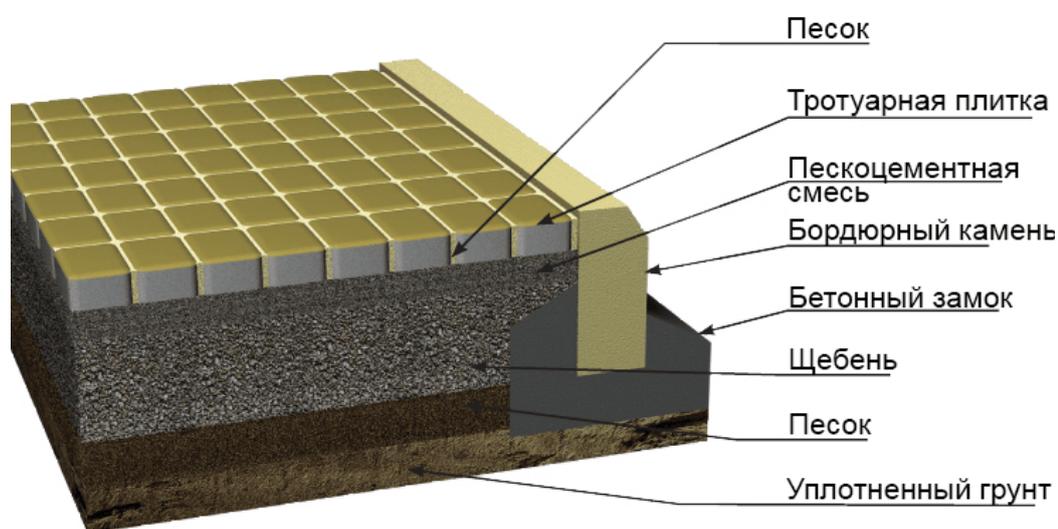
Схема покрытия с использованием бетонной плитки
